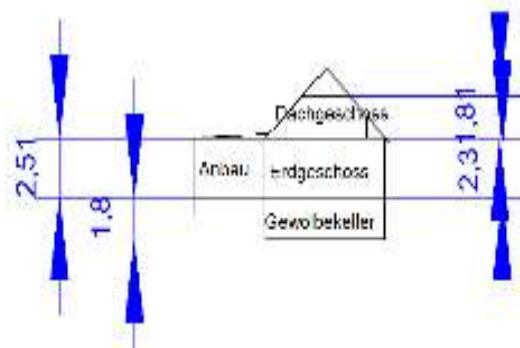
Schnittskizze Wohnhaus mit Anbau
